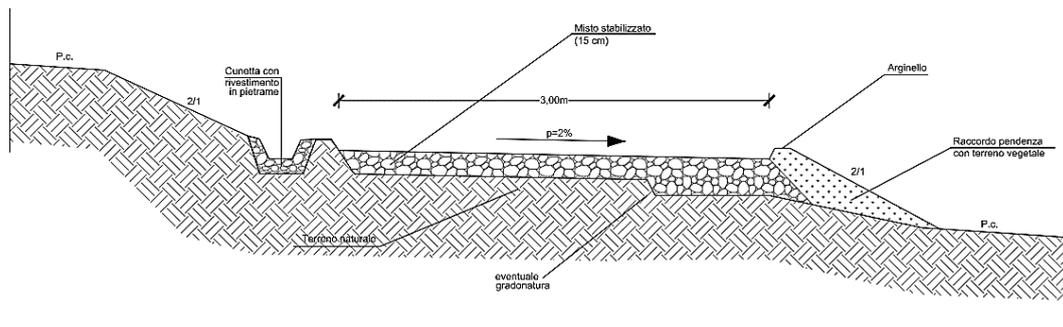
Sezione tipo strade interne al sito, tipologia a mezza costa (Fonte: ns elaborazione)
